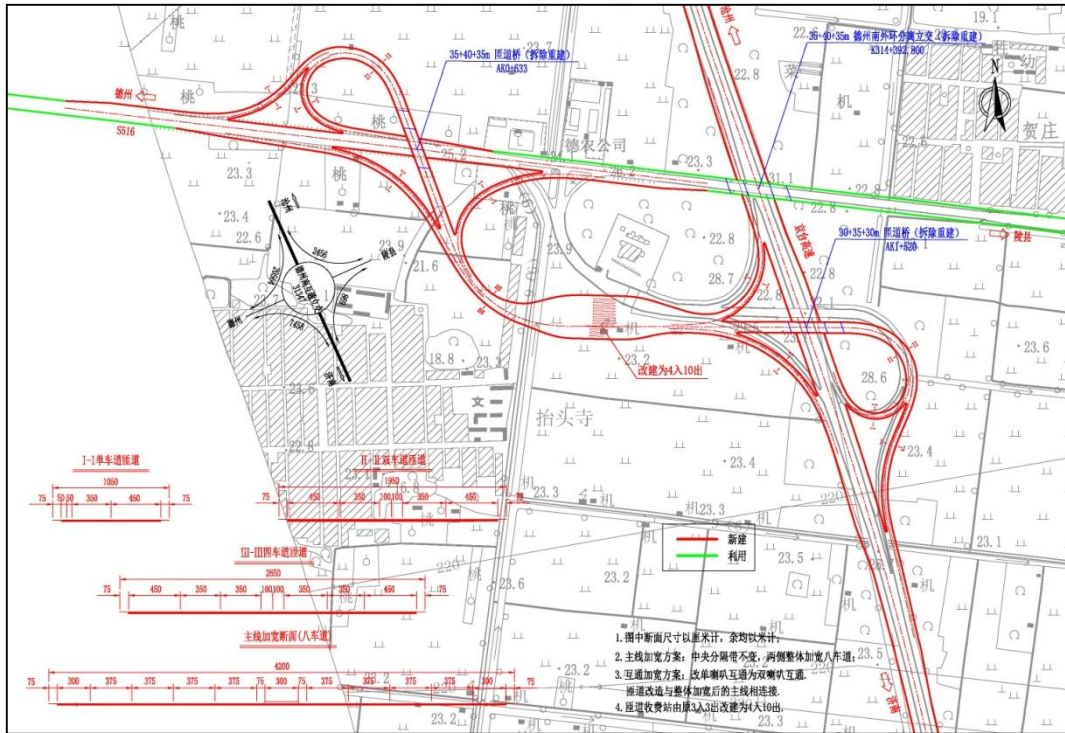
德州等喇叭型互通立交改建施工示意图
